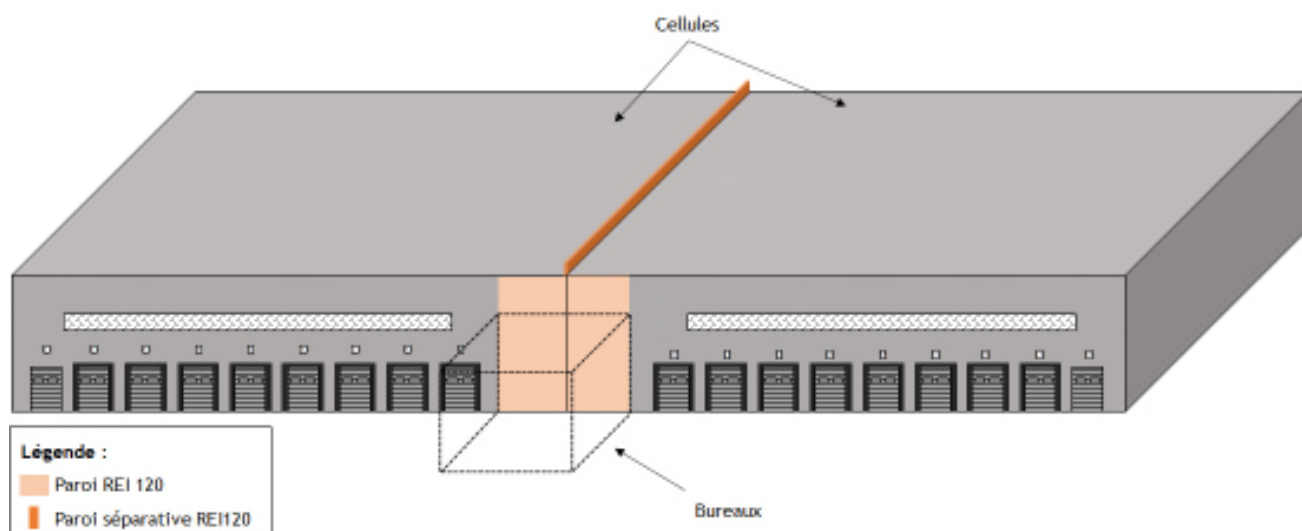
Plan des dispositions constructives des parois entre bureaux et cellules (Bureaux 2, 3 et 4)
